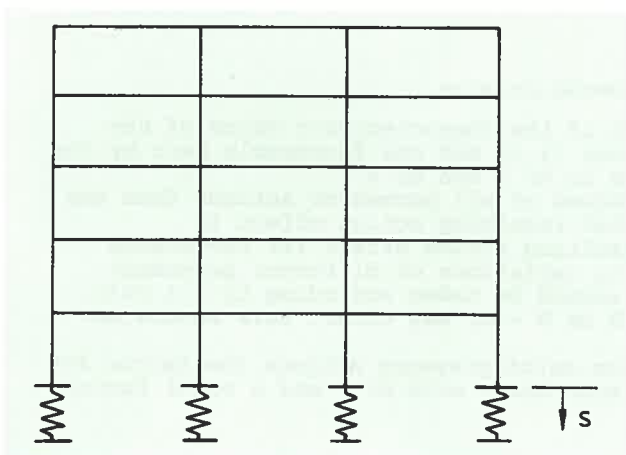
Gemeinsames Modell Tragwerk/Baugrund
